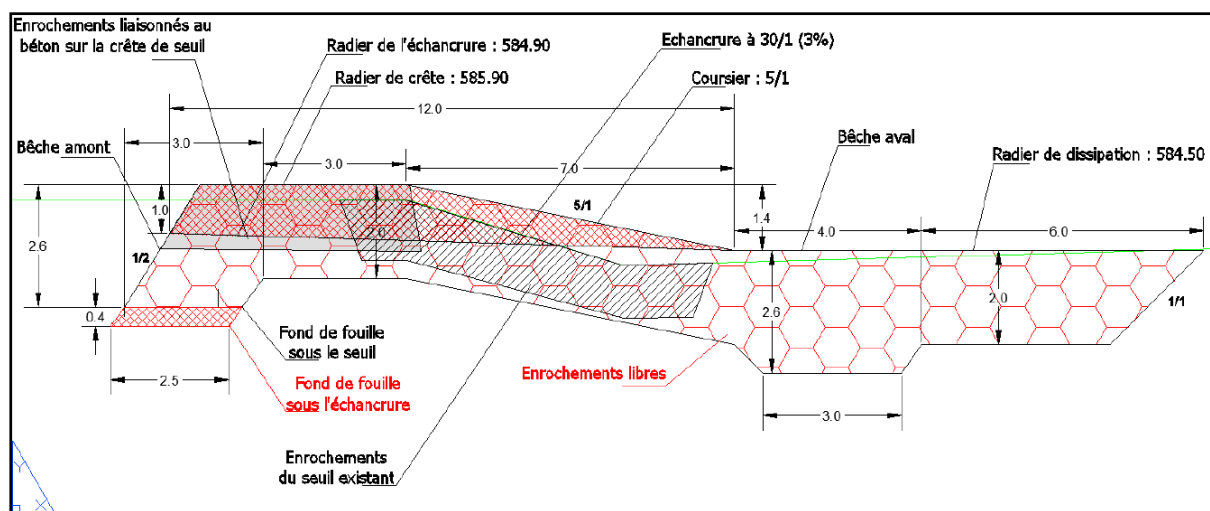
Coupe type du seuil du pont Beau de Rochas
